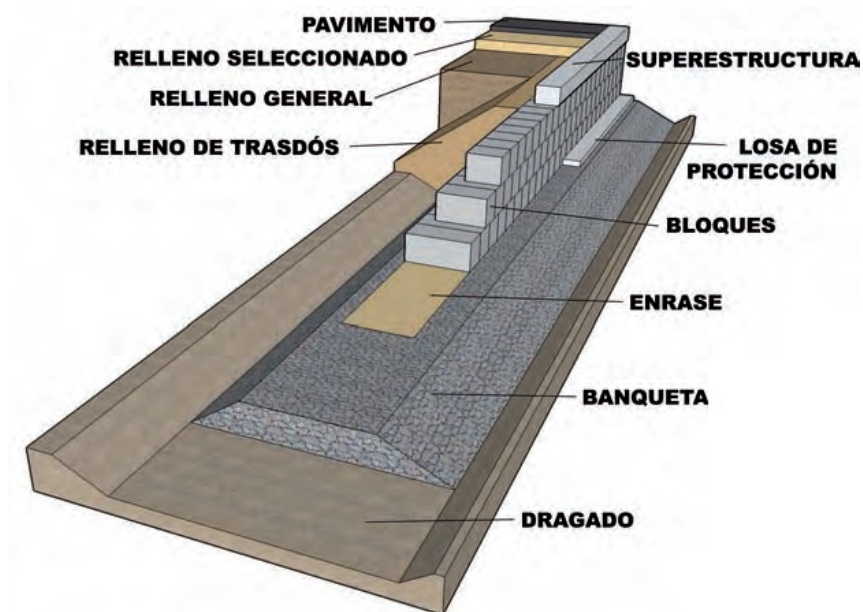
a C Secuencia constructiva muelle de bloques
